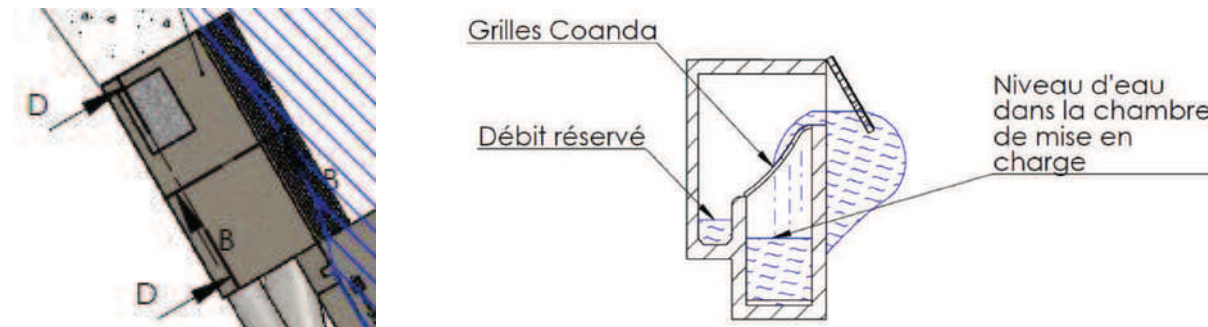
Vue en plan et coupe au niveau de la prise d'eau
